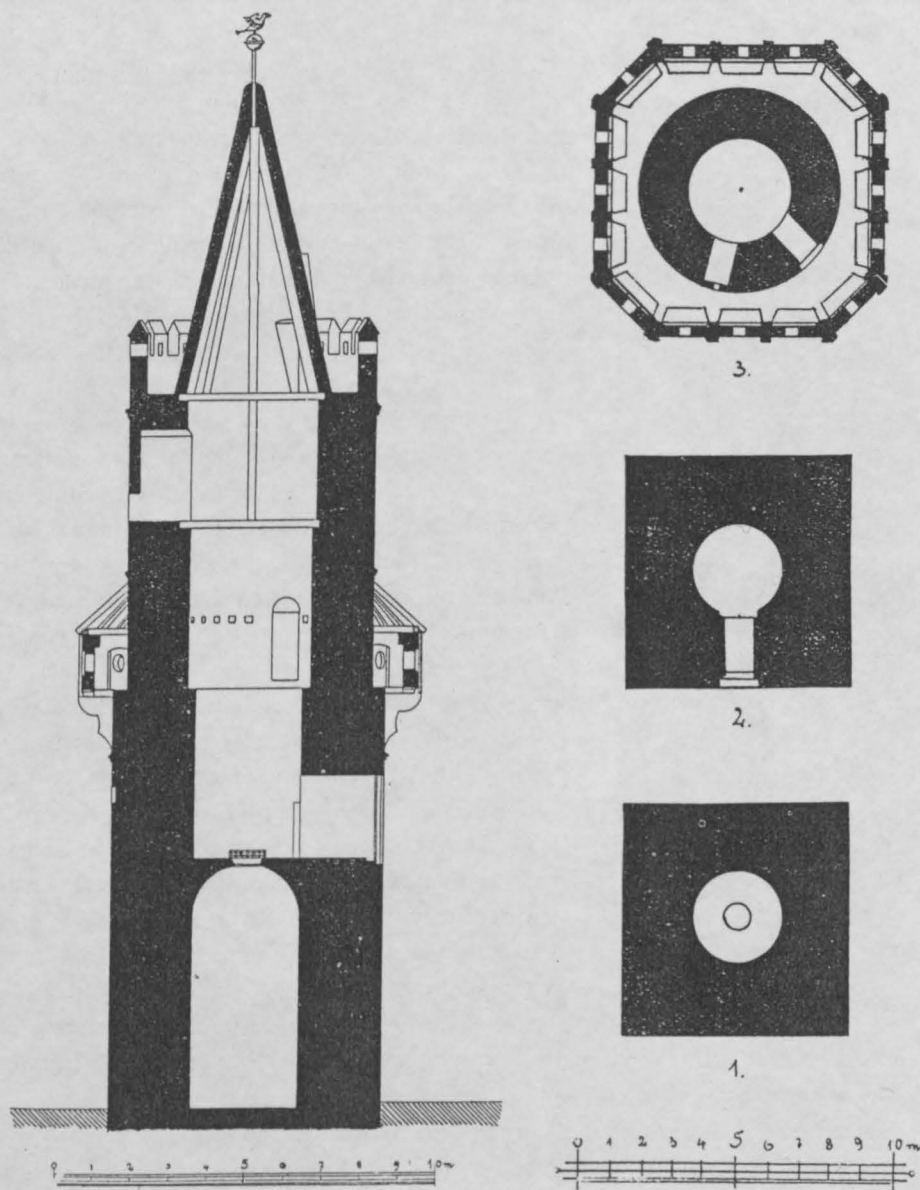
Torturm am Mitteltor in Prenzlau. Schnitt und Grundrisse.
